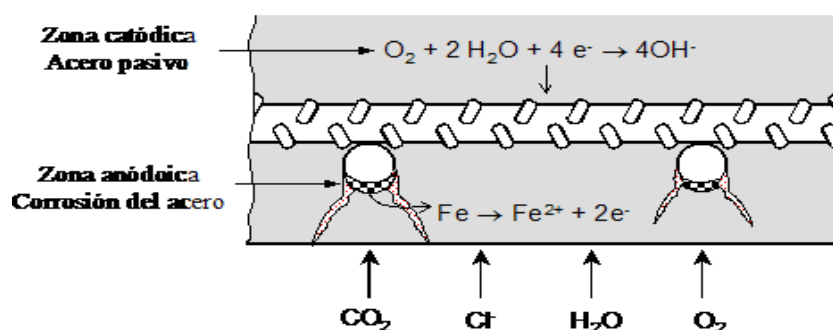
Representación esquemática del proceso electroquímico de corrosión de las armaduras en el concreto. (Fuente: Manual de Rehabilitación de Estructuras de Concreto)
